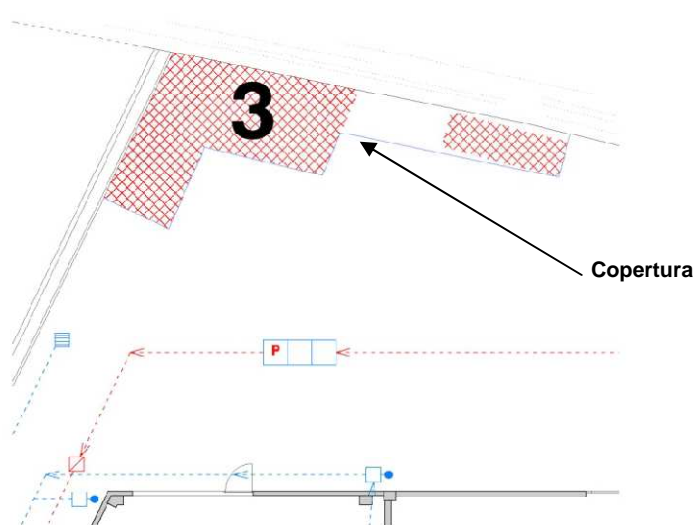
Stralcio planimetrico della proposta di copertura in riferimento all' area n.3
